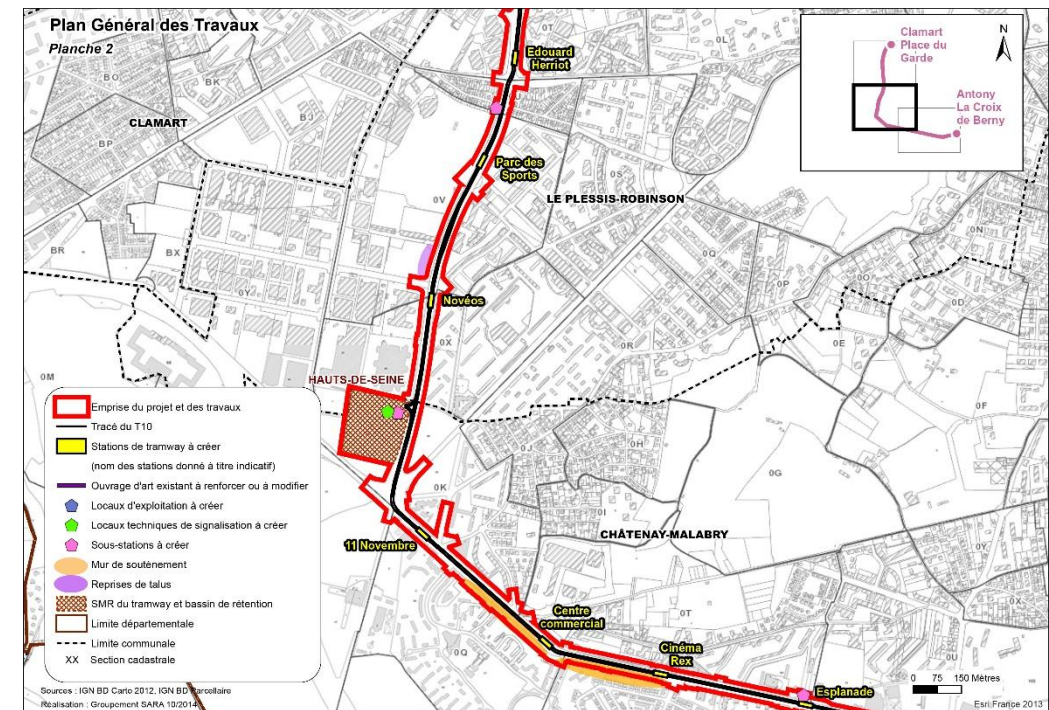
Principaux travaux et ouvrages du projet de Tramway T10 (2/3)
